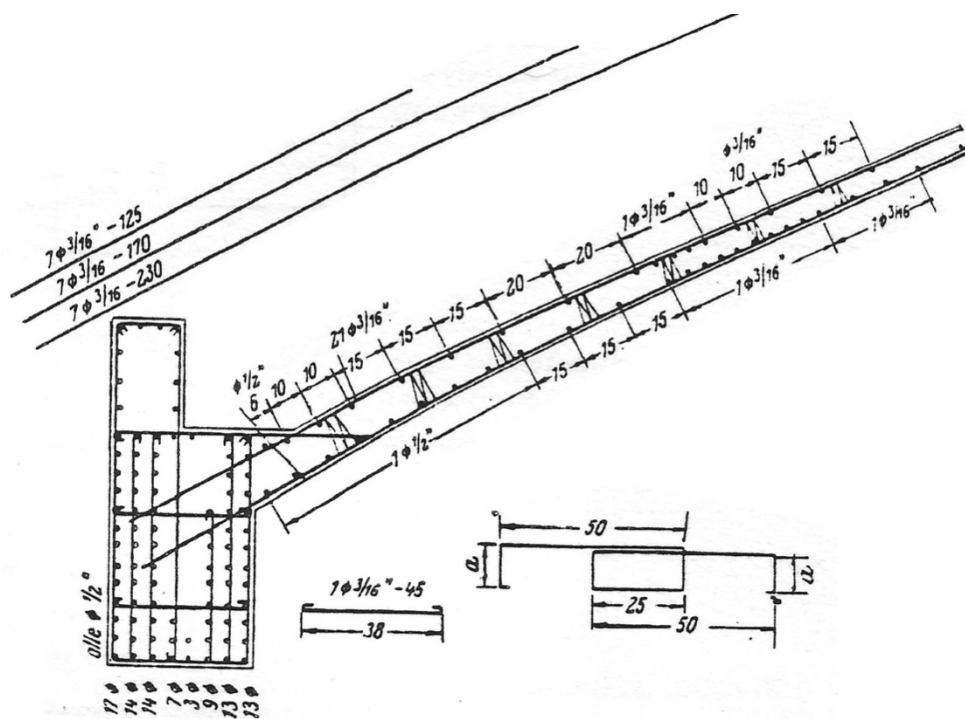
Detalhes da Cúpula do Cinema Roxy. Detalhes da armadura. Os vergalhões em forma de M, de altura variável "a", foram introduzidos, afim de manter em seu lugar a armadura superior. FONTE: CONCRETO, 1945.
